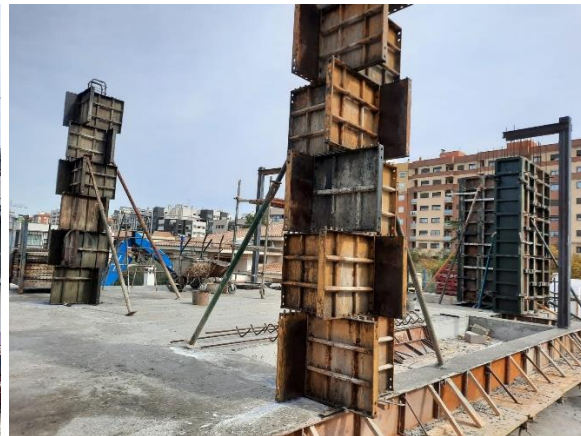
Encofrado metálico de los pilares y muros del hueco de ascensor.
